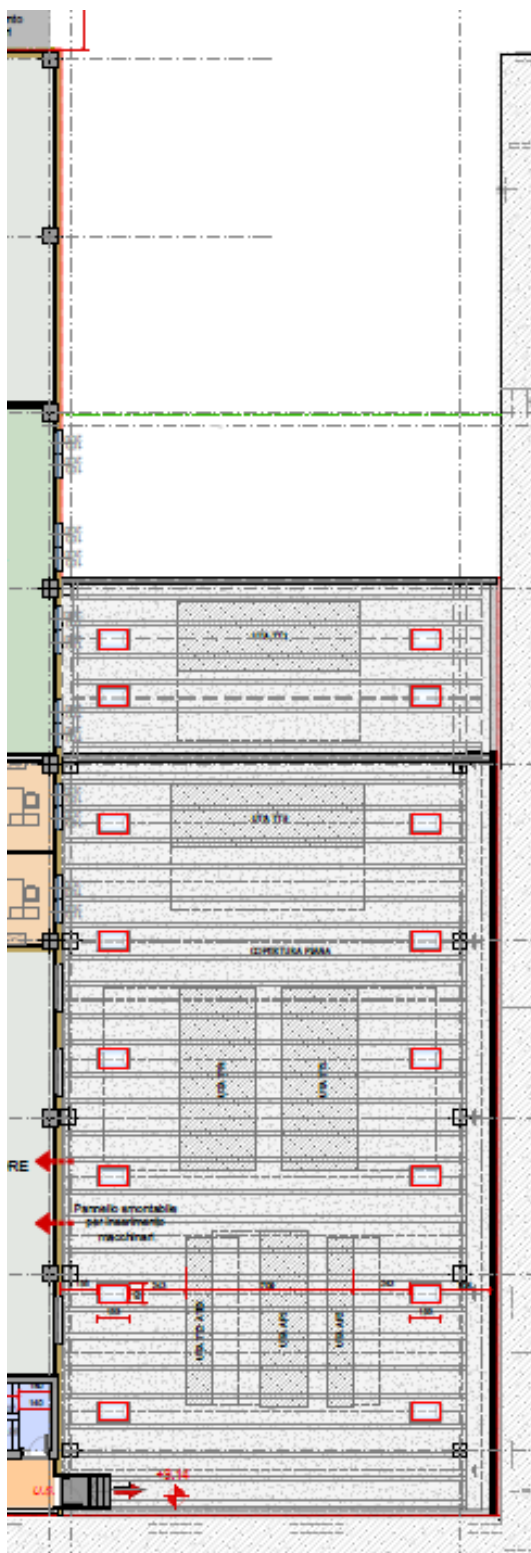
Planimetria architettonica piano P1 (copertura alta) - Nuovo magazzino spedizioni
